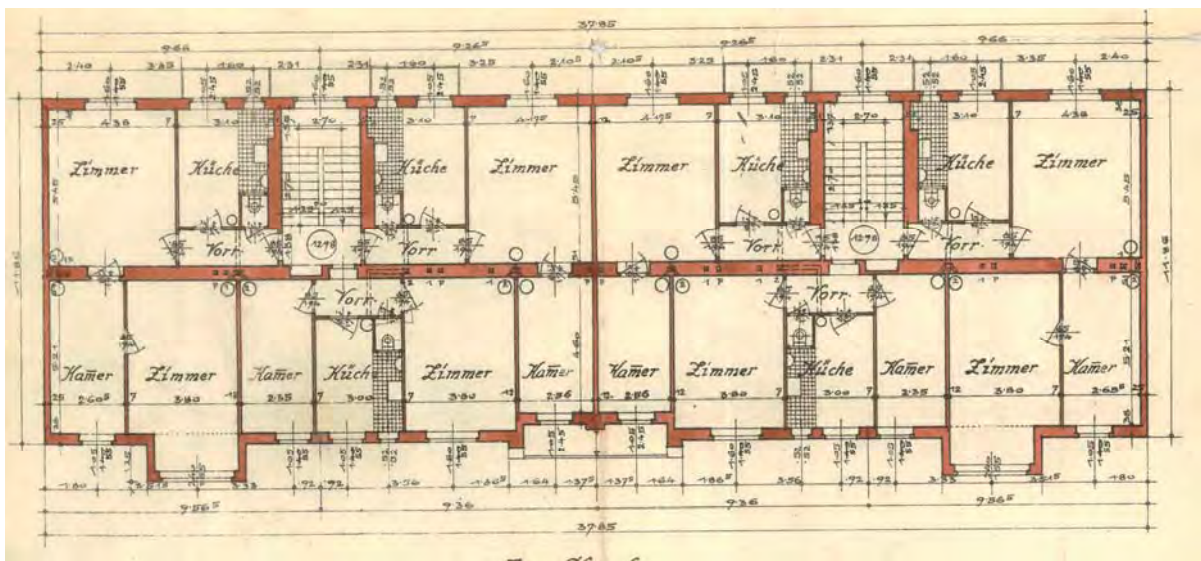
, Grundriss 3.OG, Quelle Bauakt
